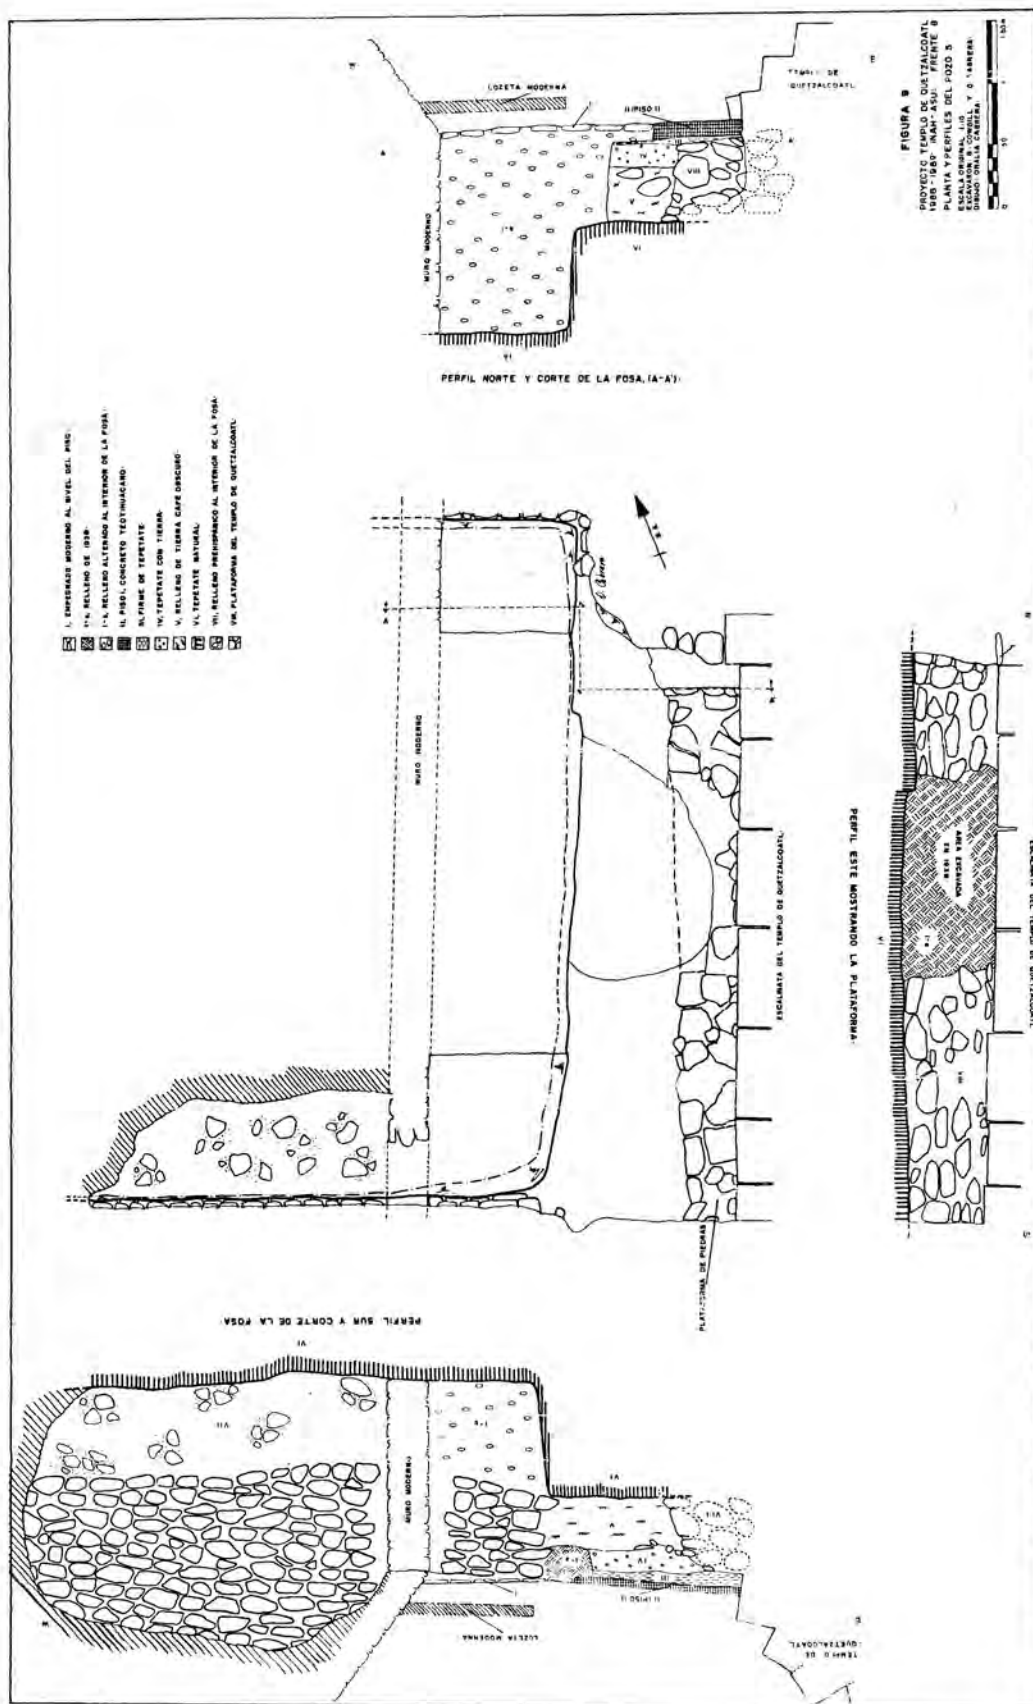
Planta y perfiles del pozo 5 ubicado al pie de la escalinata de la Serpiente Emplumada.
